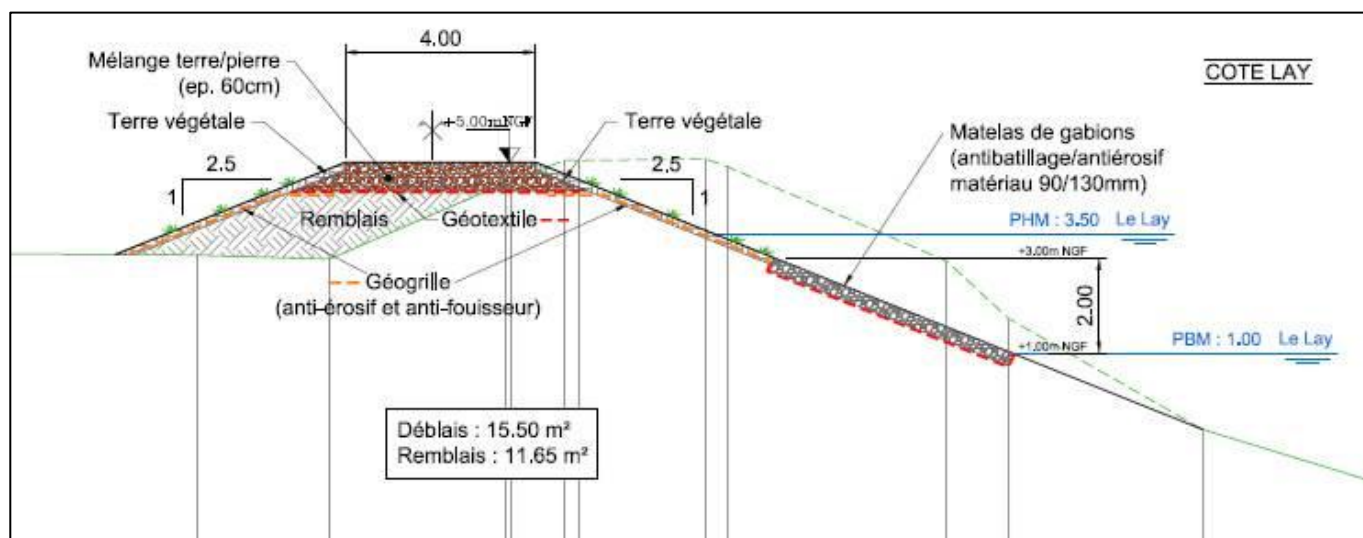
Coupe type du projet de restauration à la cote 5 m NGF (Arcadis, 2013)
